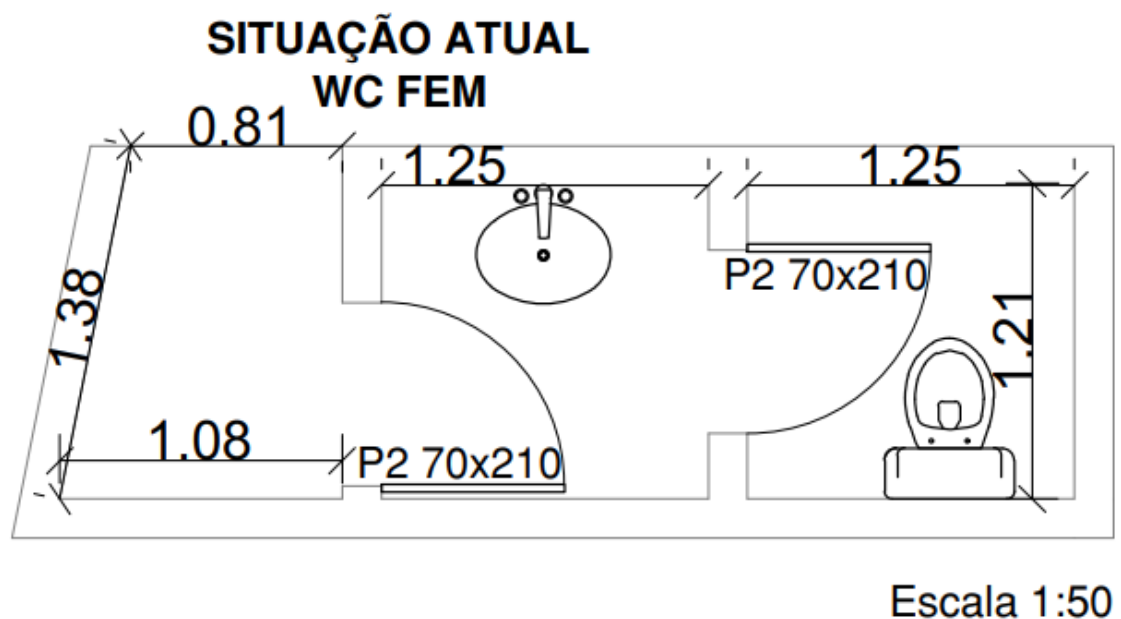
Planta com as medidas atuais dos banheiros. Elaborado pelo autor.
